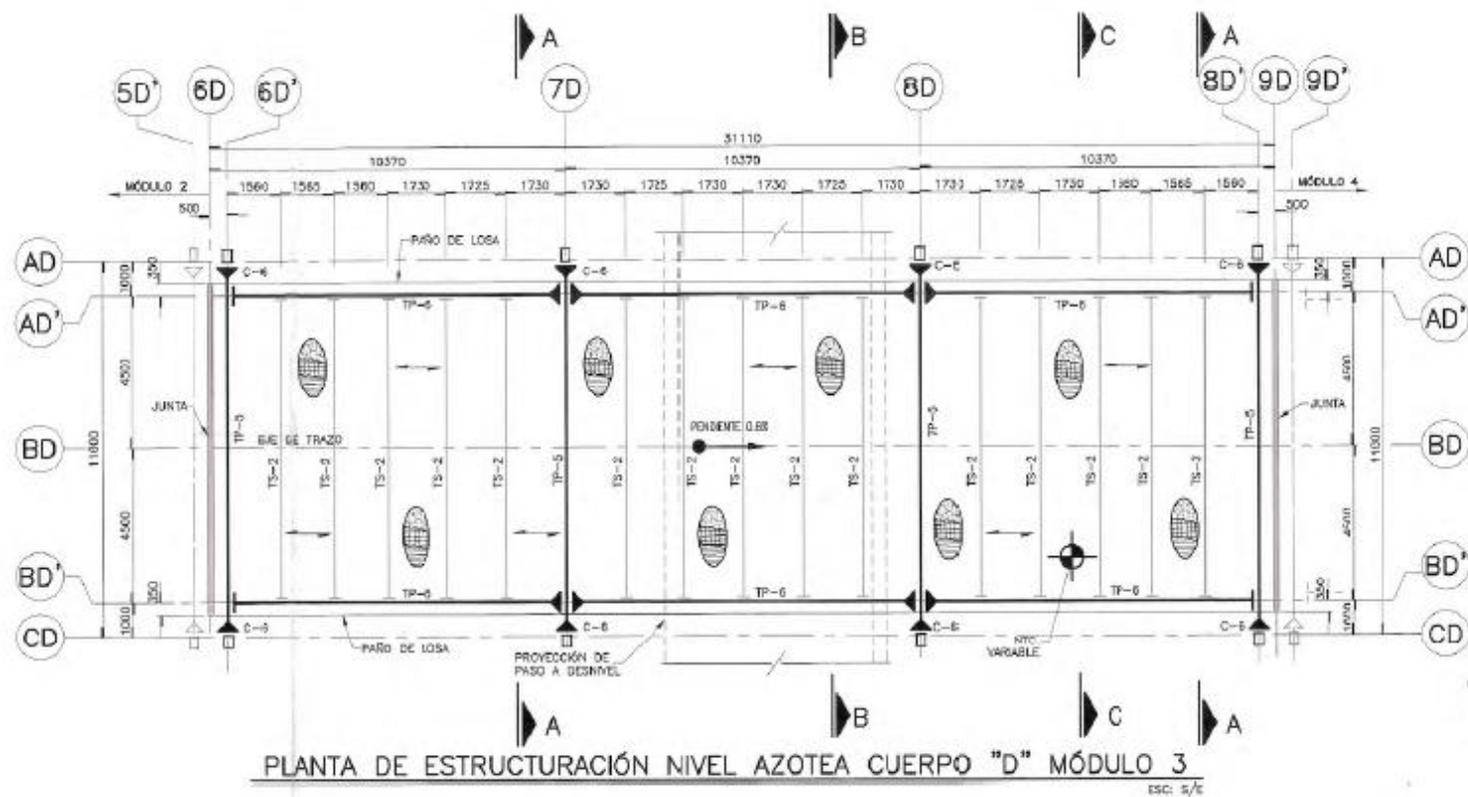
Planta de estructuración nivel azotea, módulo 3.
